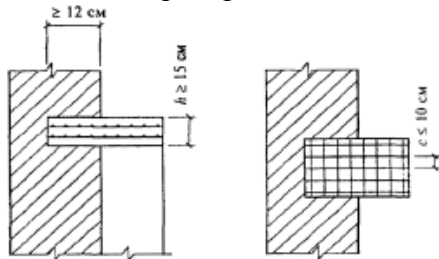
Установка железобетонных распределительных плит на пилястры
